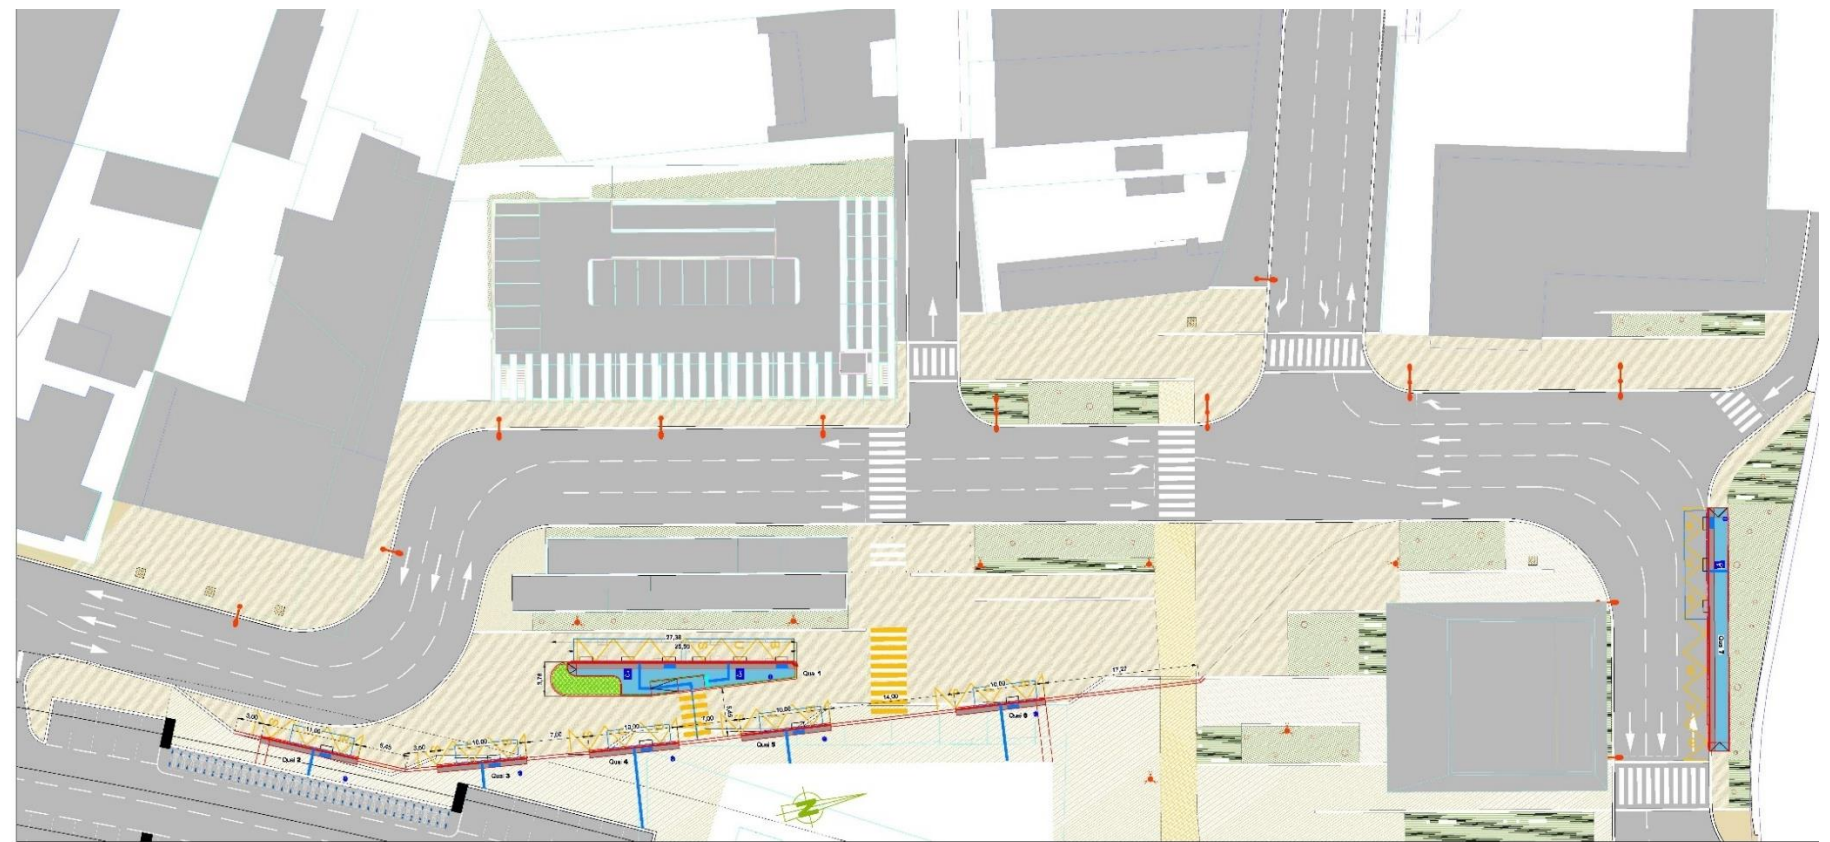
Plan d'aménagement des quais de la gare routière (Source : MNCA)
